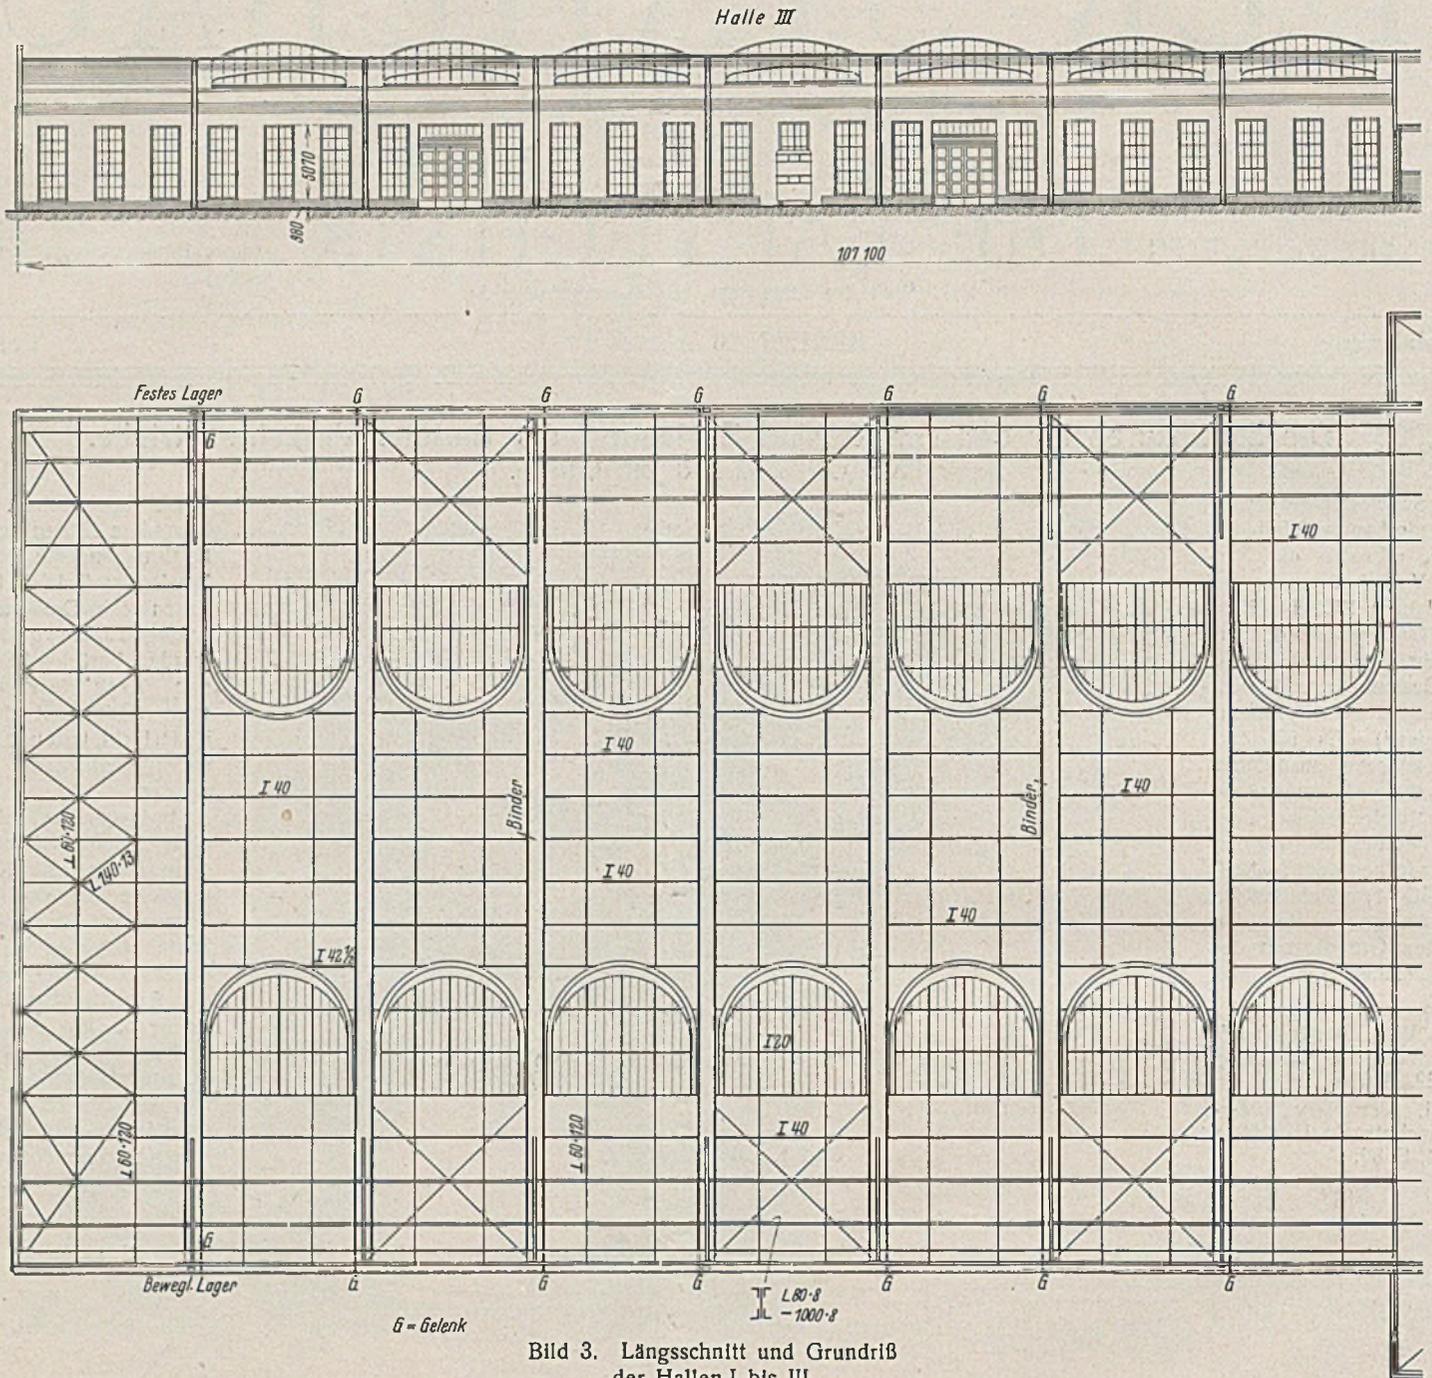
Längsschnitt und Grundriß der Hallen I bis III.
